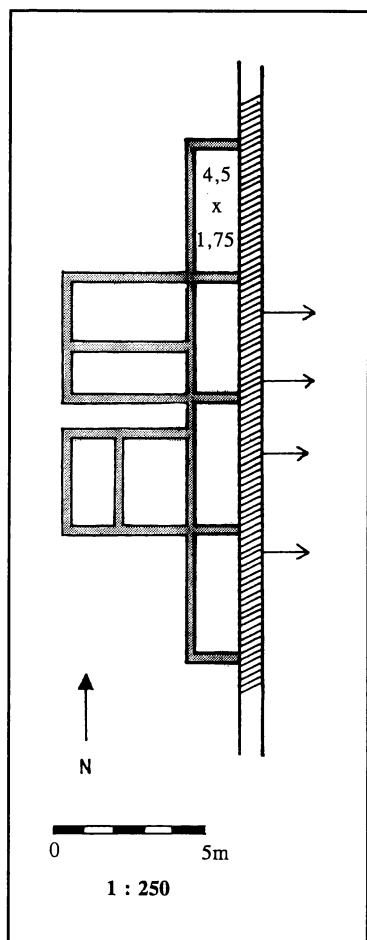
Ḥirbet Raddāne: Grundrißskizze des Haustyps mit Querraum und ohne Pfeilerreihe
